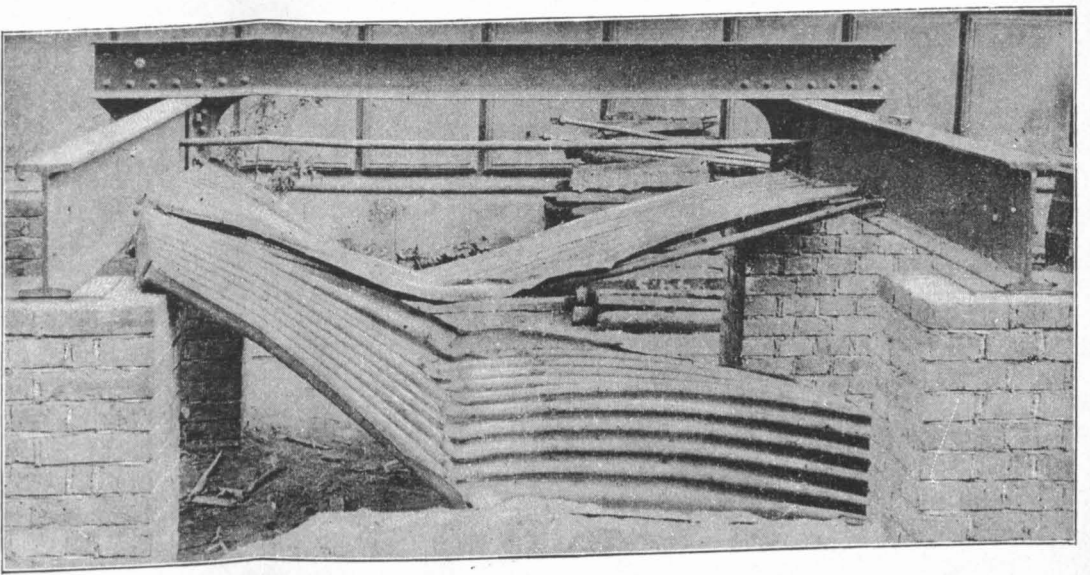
Monier- und Beton-Gewölbe mit 4'05 m. Spannweite.
